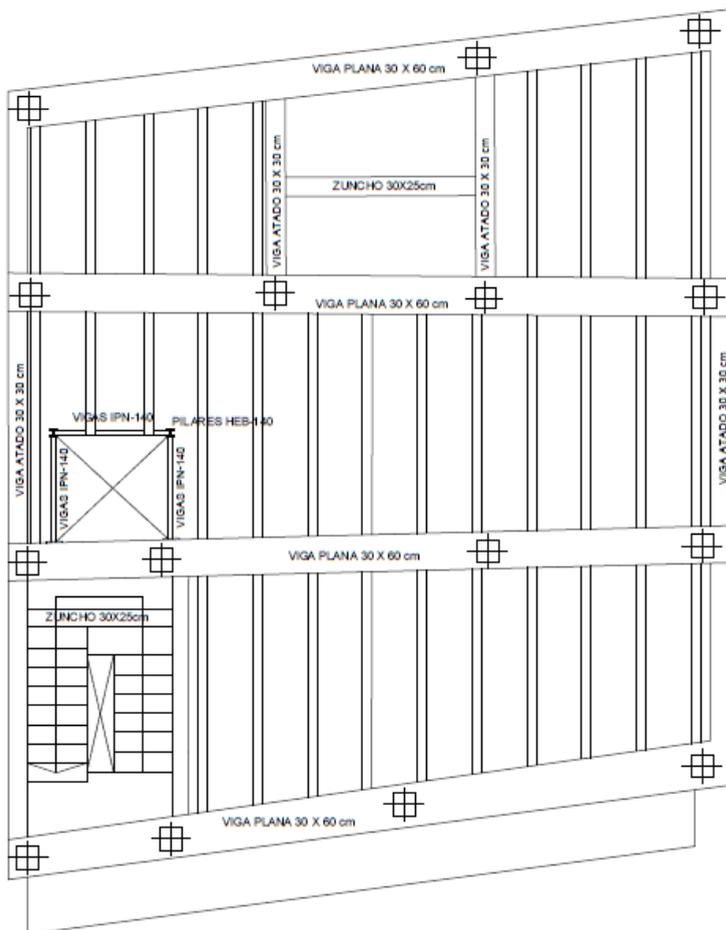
Estructura modificada forjado 2-3-4. Fuente propia.
